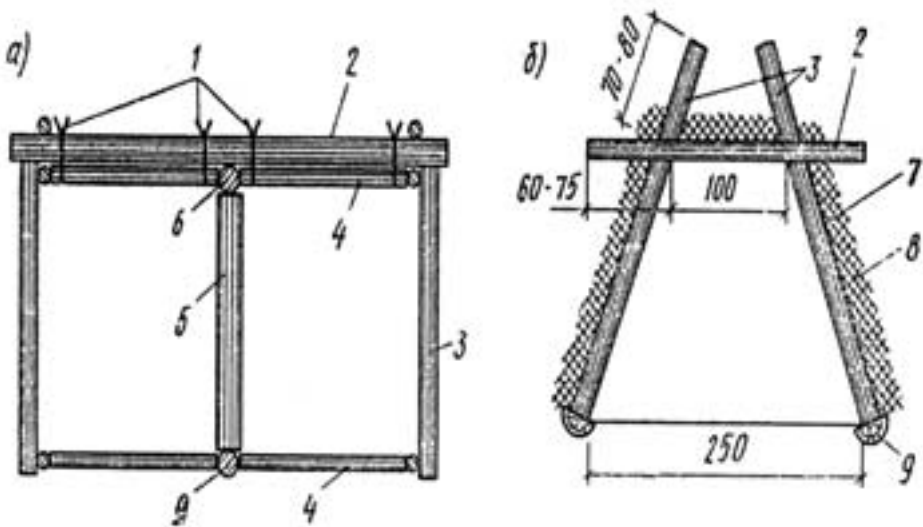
Конструктивні рішення сховищ, виконаних із дерева: а) безврубова конструкція; б) спорудження податливої конструкції; 1 – дротові скрутки; 2 – елементи накату; 3 – стіна; 4 – розпірки; 5 – стійка; 6 – прогін; 7 – гідроізоляція; 8 – амортизаційний шар; 9 – лежень.
